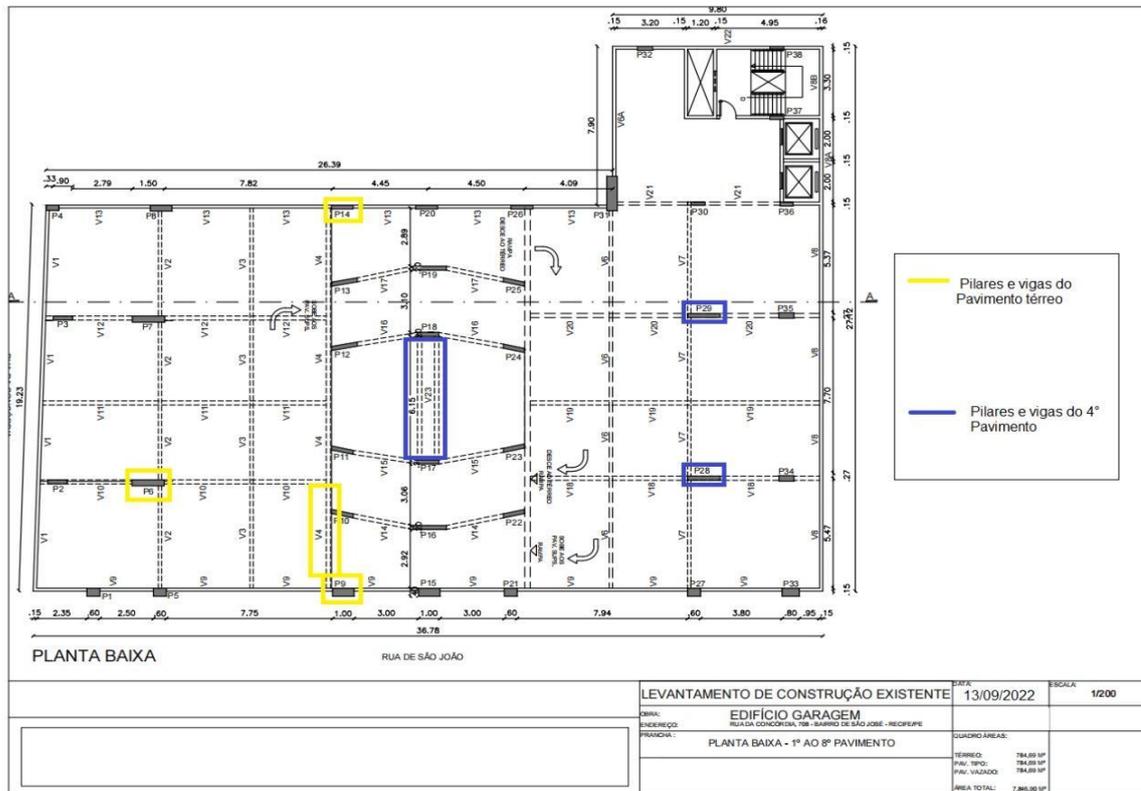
Mapeamento do ensaio de pacometria de vigas e pilares do pavimento térreo
